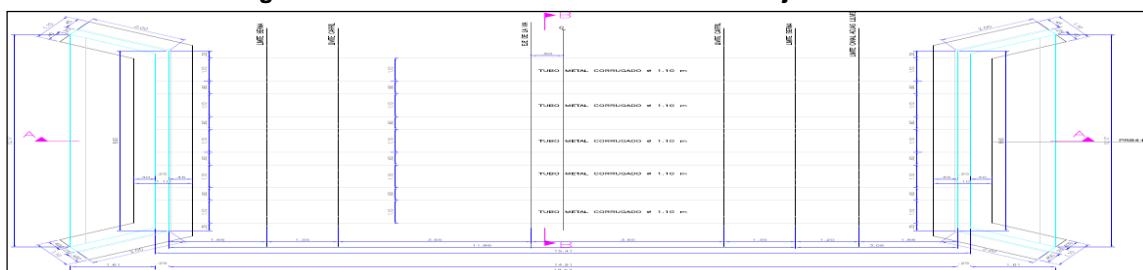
Planos de diseño de planta Box Culvert corte B-B para la obra de drenaje PR84+900
